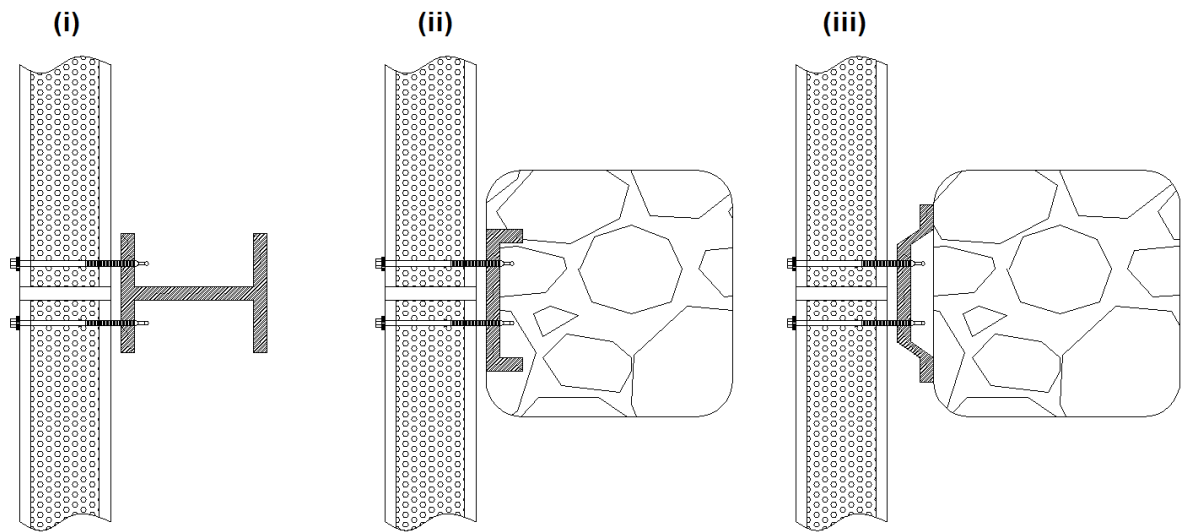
Diversas ligações entre Painel e elemento estrutural (adaptado de [11]).
